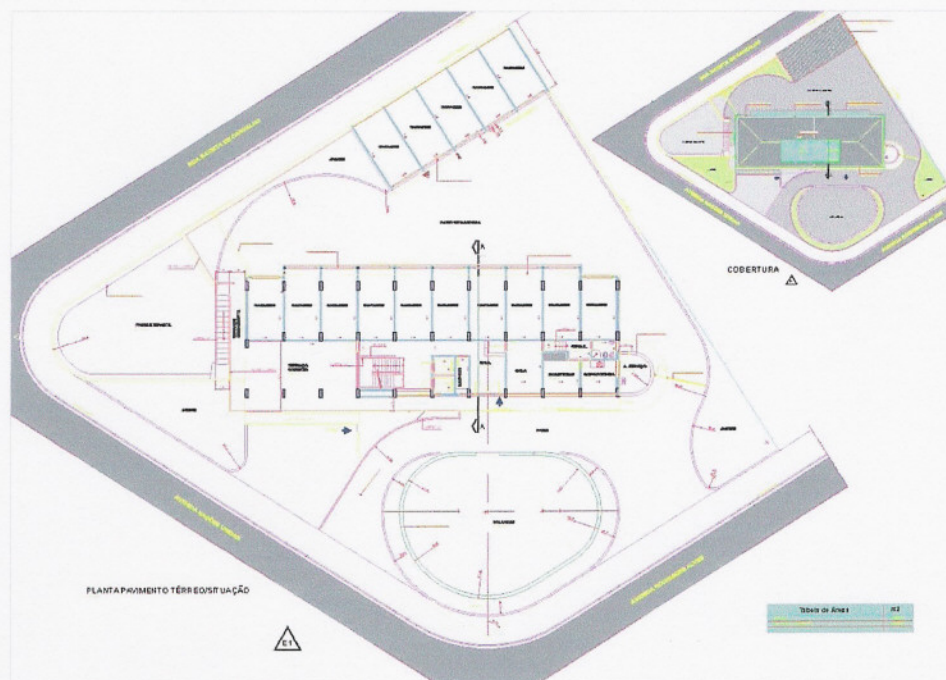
Planta do pavimento térreo/situação do Edifício Brasil Portugal
